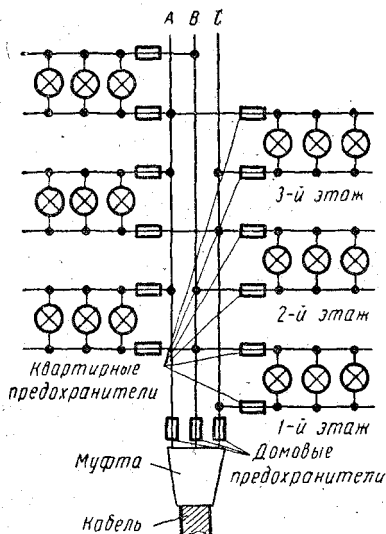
Схема трехпроводной осветительной сети жилого дома при соединении фаз нагрузки в треугольник
